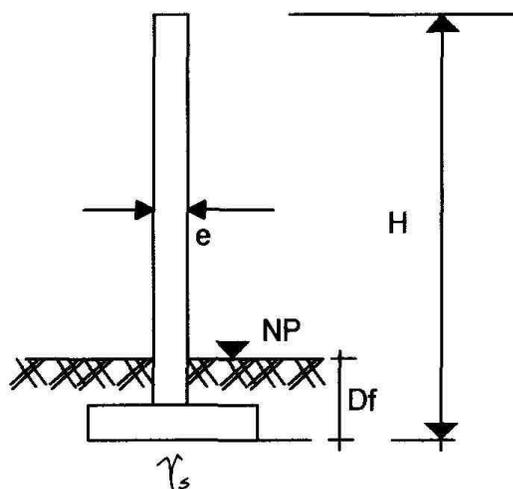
Mecanismo de funcionamiento de muros de retención en viviendas
